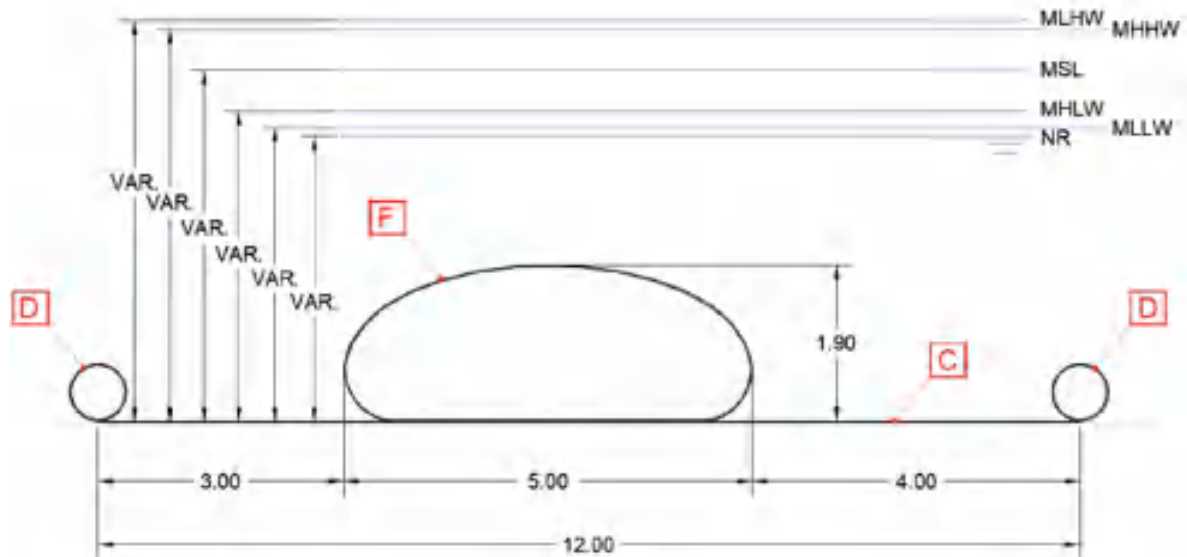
Seção transversal do segmento transversal da obra-piloto em seu trecho submerso. Fonte: Garcia e Gireli, 2019.
